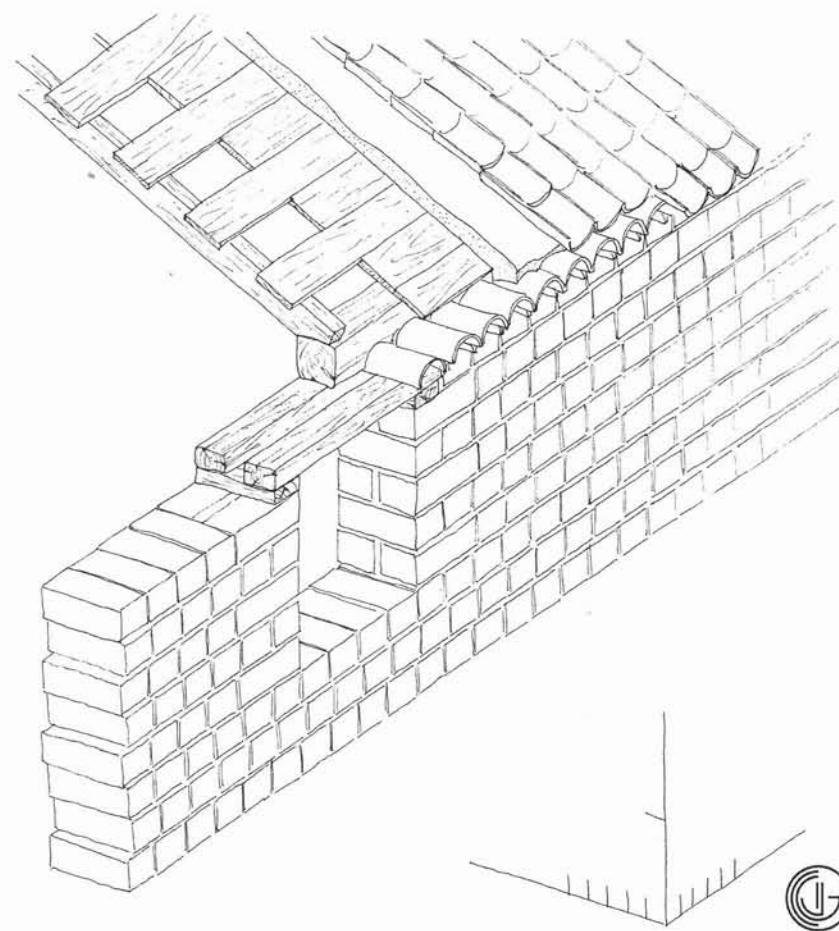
Cargaderos de madera para resolver un hueco en un muro de adobe a tizón y apoyo de la cubierta sobre el muro de carga
